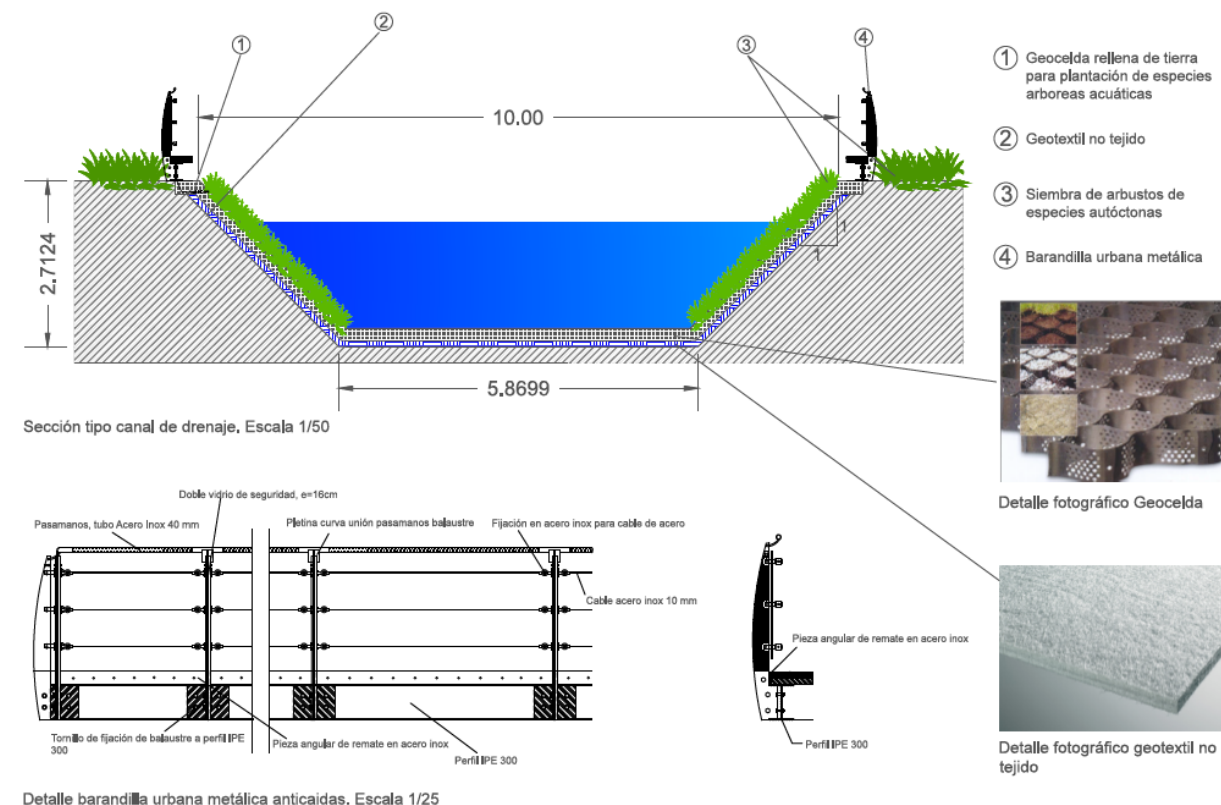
Sección tipo balsa de retención de los canales de drenaje en lámina libre.
